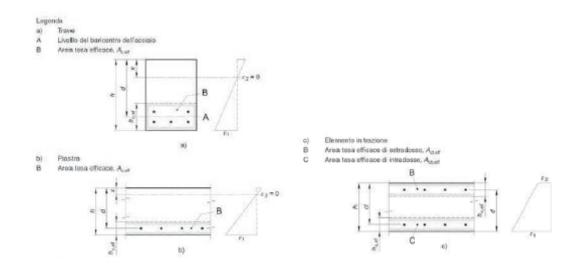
Area tesa efficace. Casi tipici.
